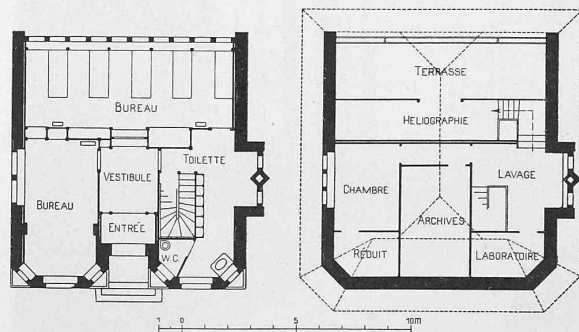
und 4. Grundrisse vom Erdgeschoss und Dachstock.
